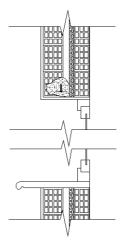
Encuentro de fachada enfoscada con ventana. Fuente: Edición propia
